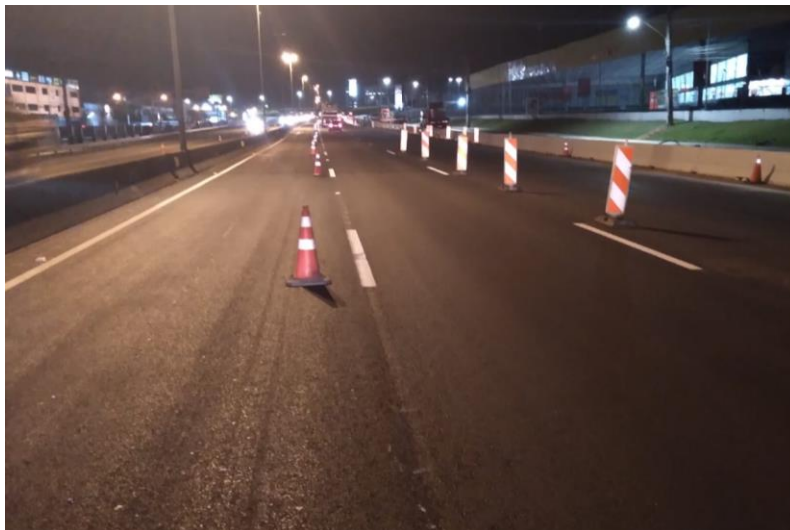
Sinalização horizontal faixa 1 – km 205.
